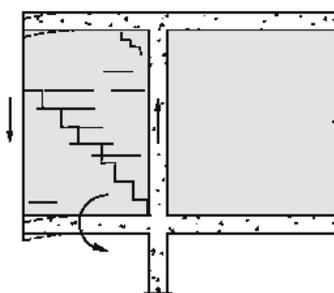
Fissuras na alvenaria, provocadas por deformação da viga na região do balanço
